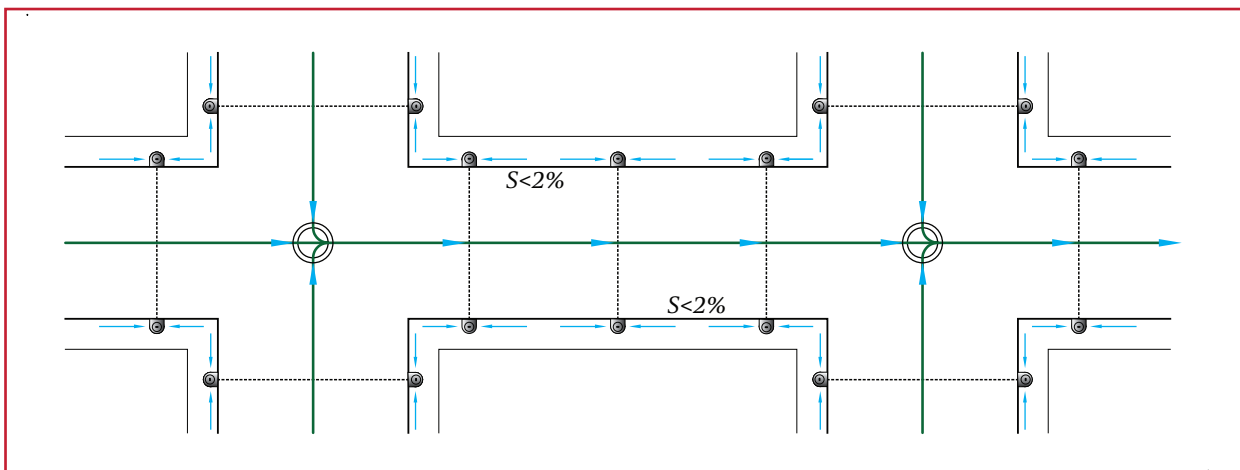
Ubicación de coladeras de piso y banqueta
